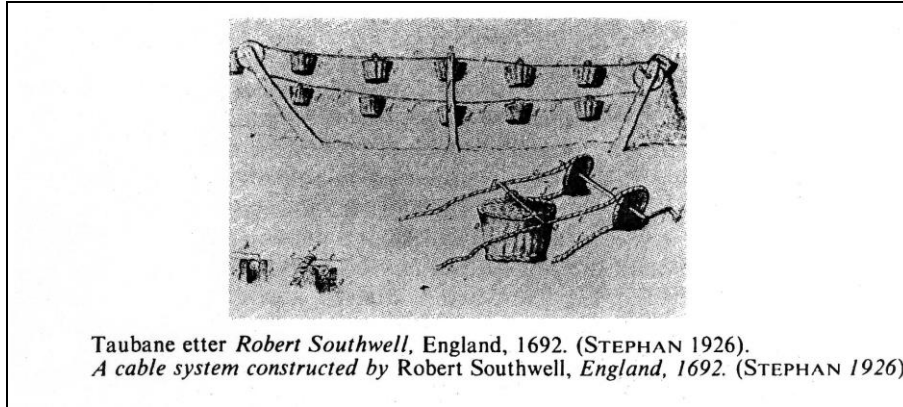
système de câble construit par Robert Southwell (Source : Samset, 1981)
